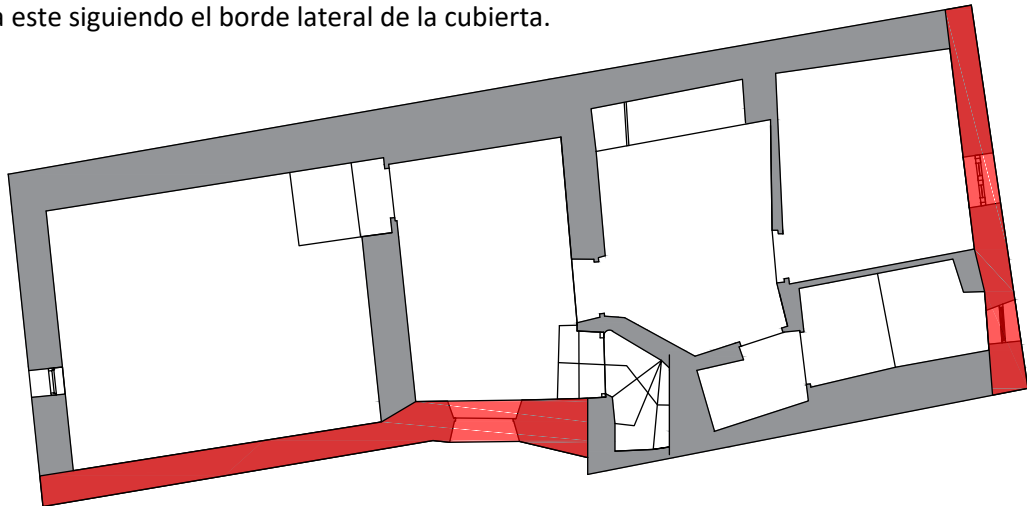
Manchas verticales en fachada Norte. Fuente propia.
